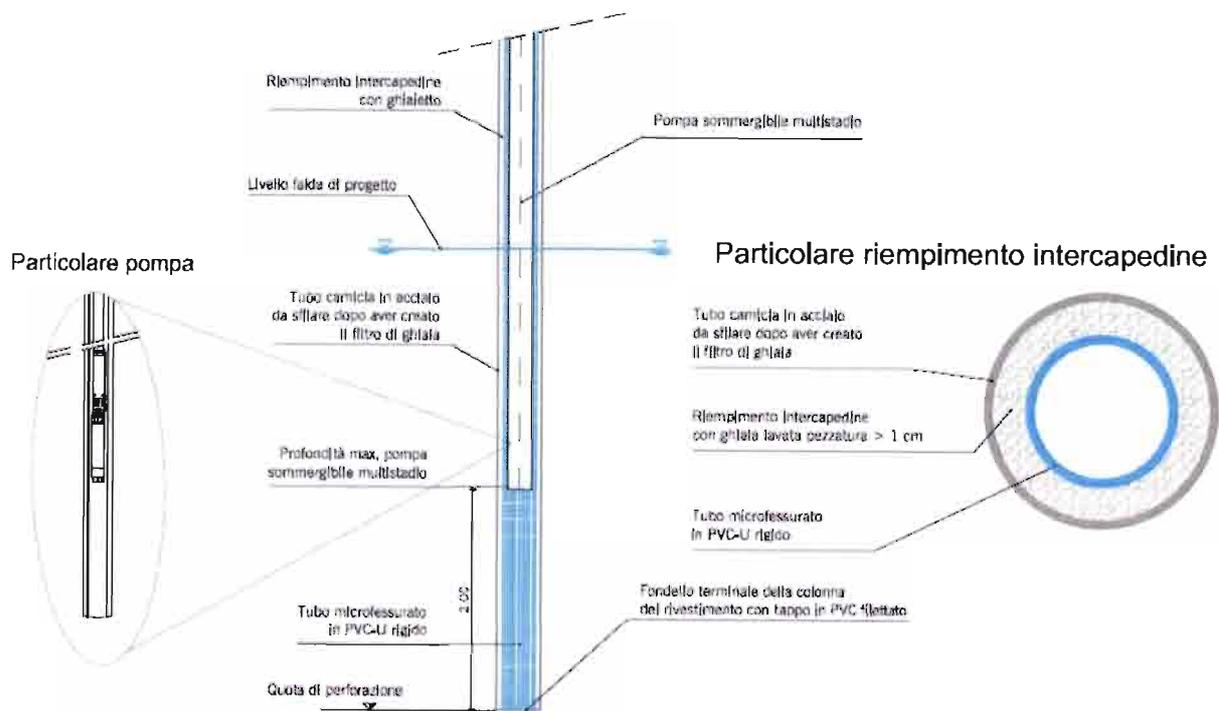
Sezione tipo del pozzo e particolare riempimento interapedine.
